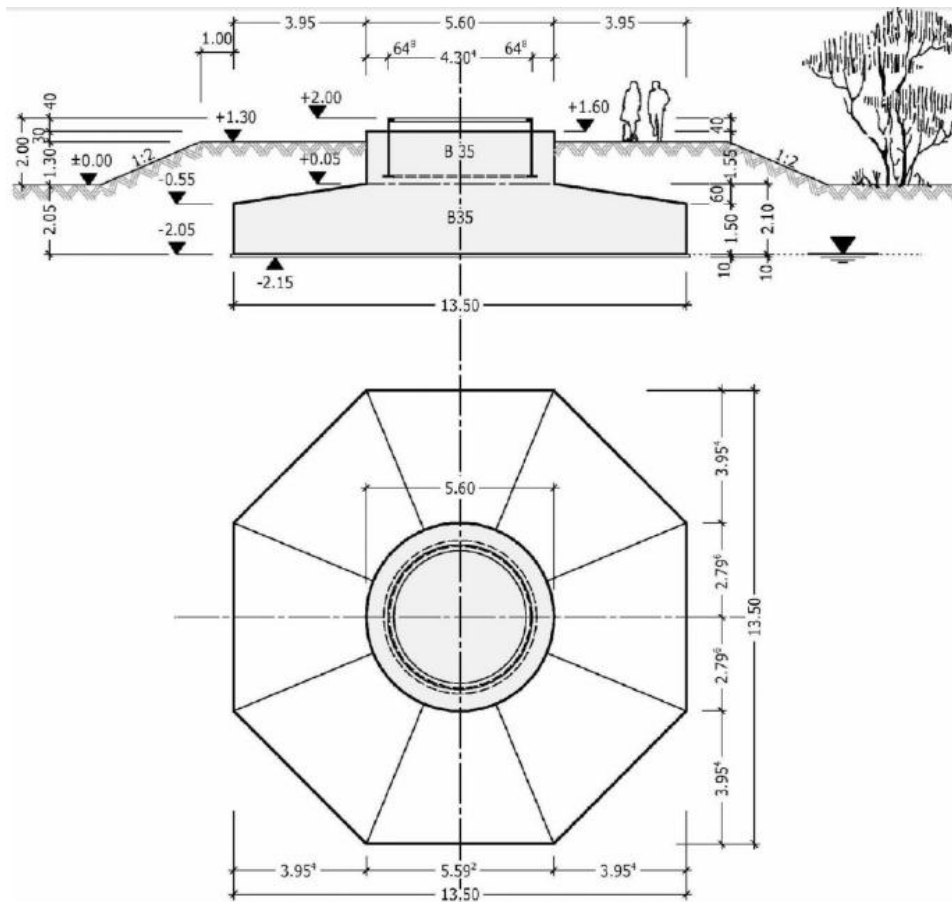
Esquema da planta e alçado da fundação da torre [33]
